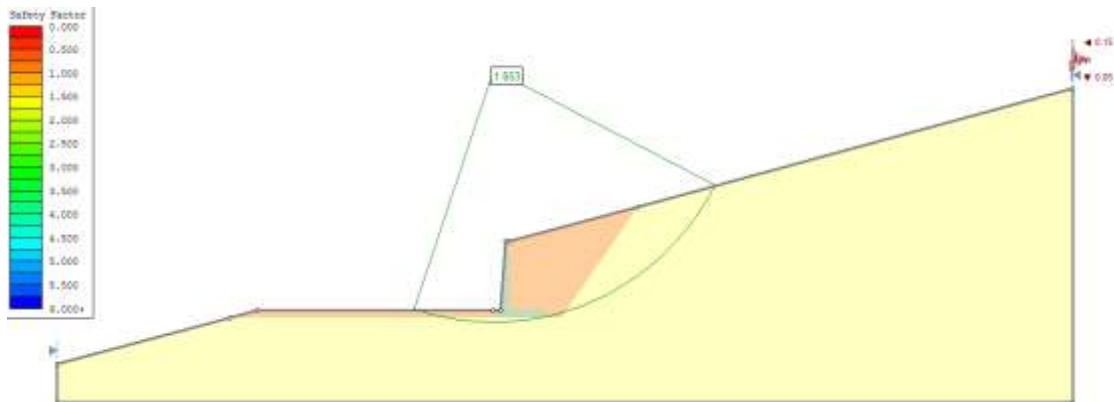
MURO CANTILÉVER FASE IV, NO DRENADO CON SISMO
